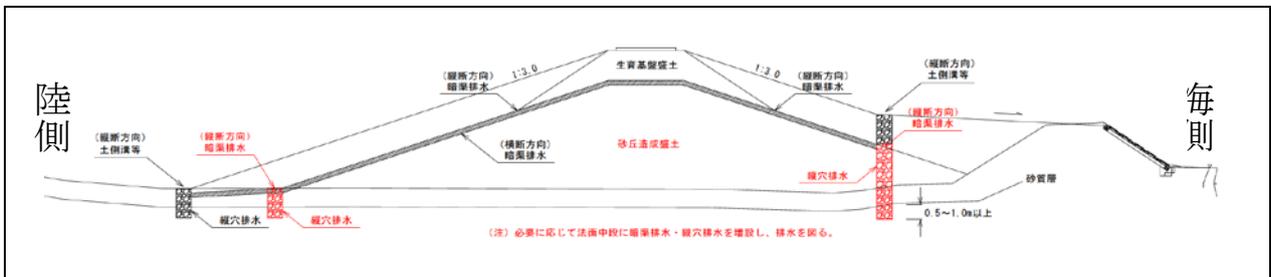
標準排水処理断面図 (赤字：市施工 黒字：県施工)
